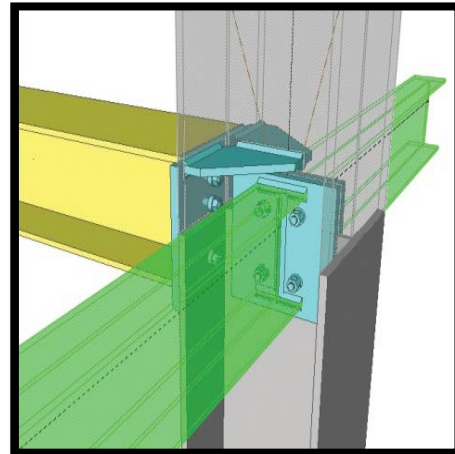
fixation de la solive sur la poutre par des cornières boulonnées.
